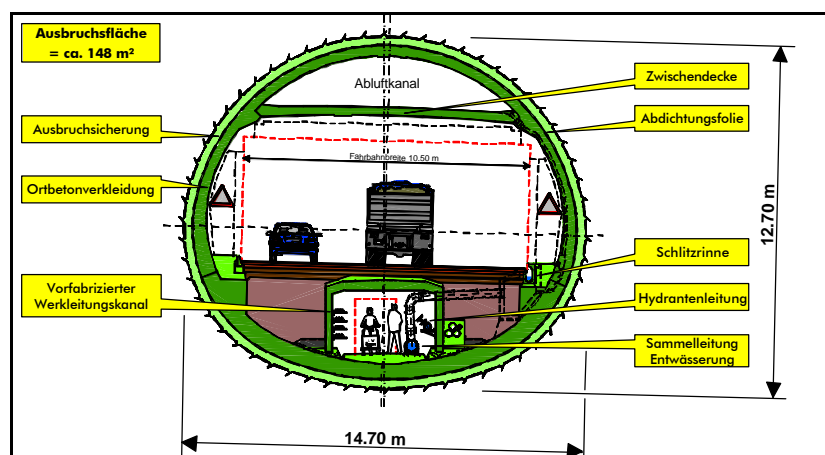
Bild L: Normalprofil Lockergesteinsstrecken und Molassestrecke Eichholz
